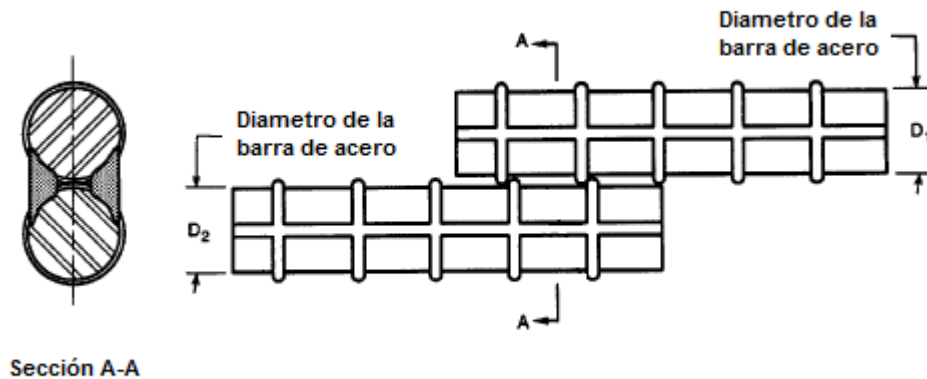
Soldadura de junta a solape con cordón simple
